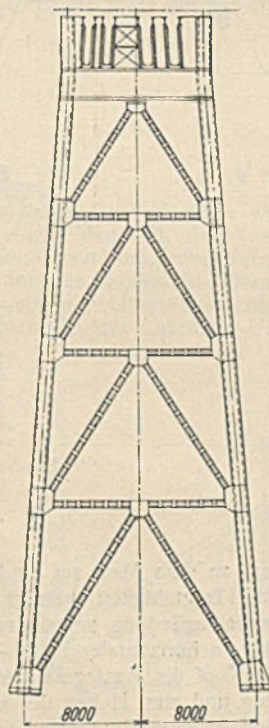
Ansicht a—b der Fachwerkstrebe. (vergl. Abb. 1 rechts).
